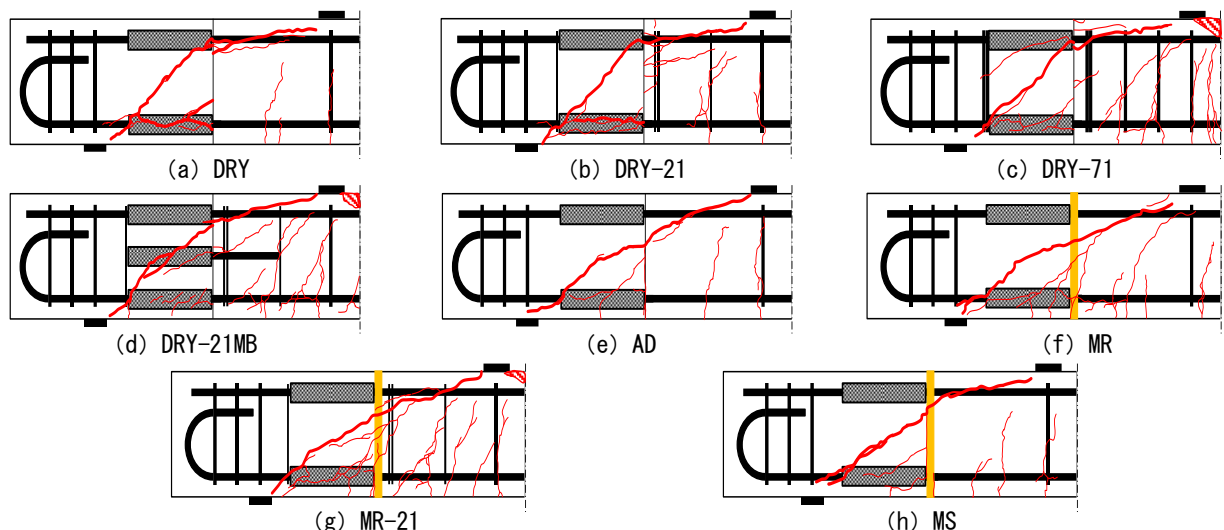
最大荷重直後のひび割れ性状（太線は顕著な斜めひび割れ，斜線部は曲げ圧壊部）
